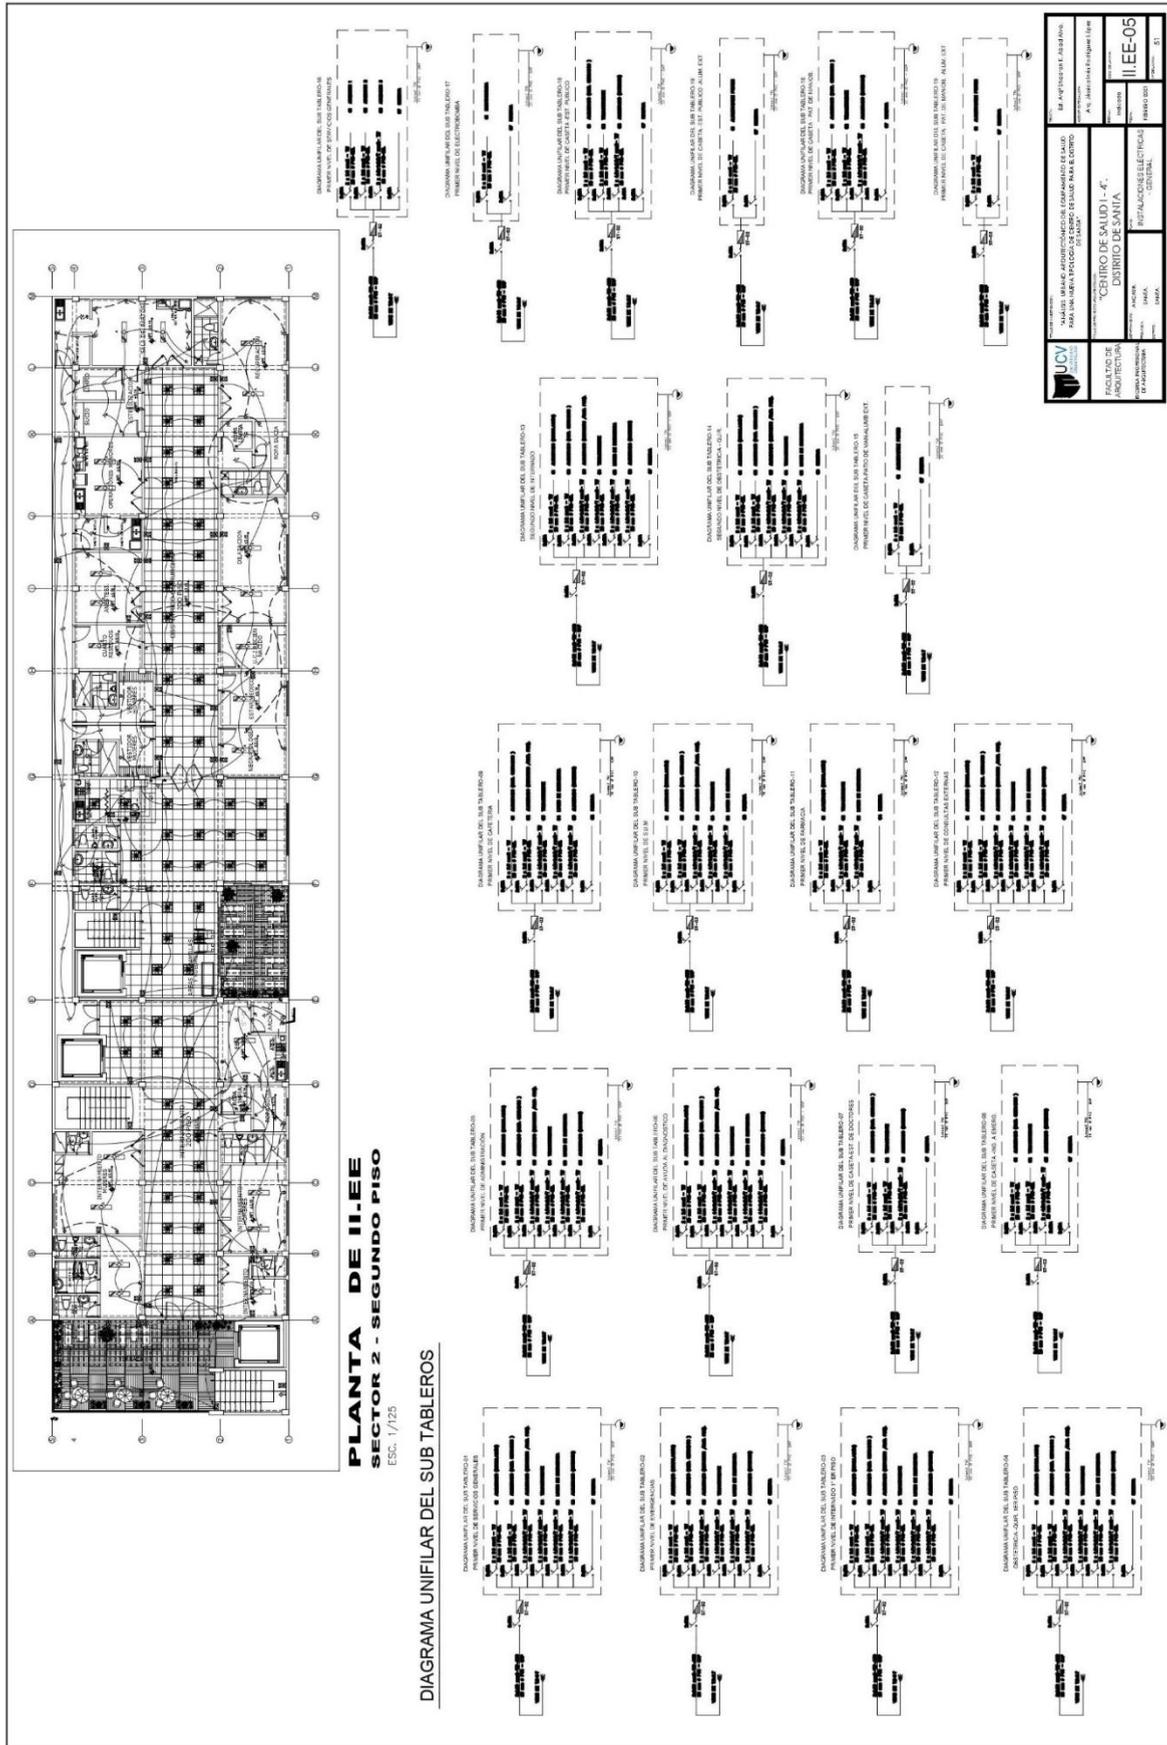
PLANO DE RED ELÉCTRICA SECTOR 2-2°NIVEL
